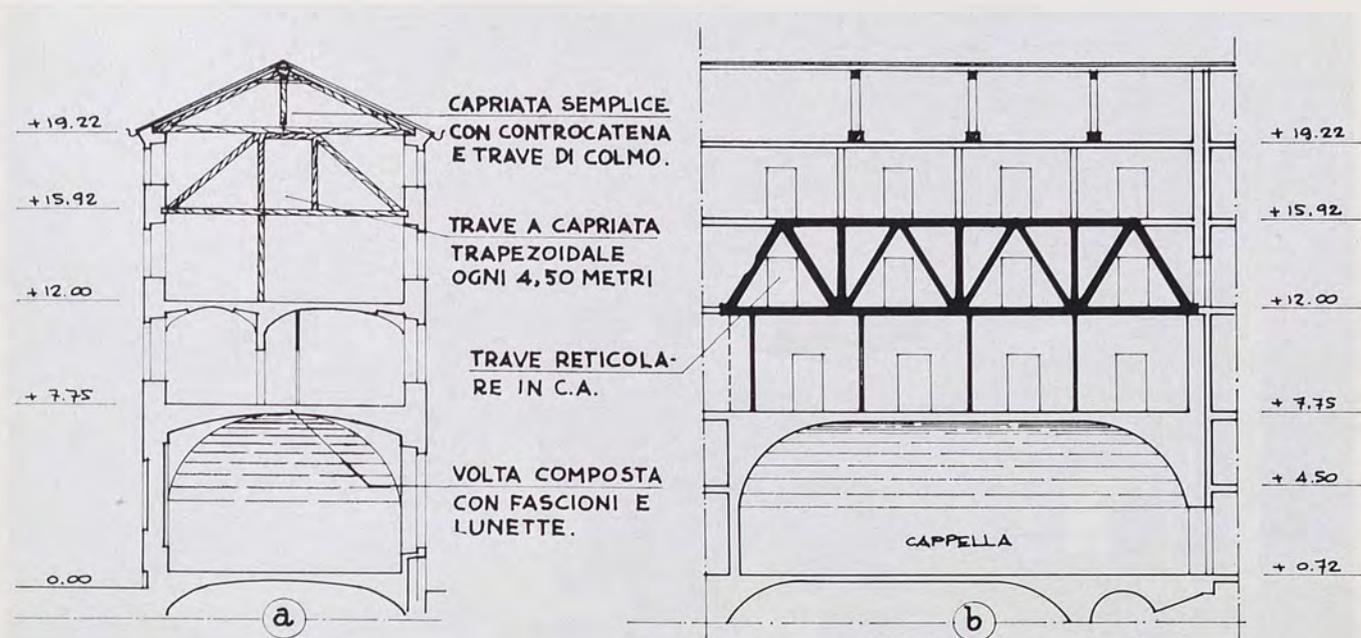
La manica su via delle Orfane, a) sezione trasversale sulla struttura lignea preesistente; b) sezione longitudinale parziale sulla struttura sostitutiva in c.a. costituita da una trave reticolare, a due correnti orizzontali, montanti e diagonali, appoggiata agli estremi, luce netta 18 m, lunghezza totale 18,90 m.
